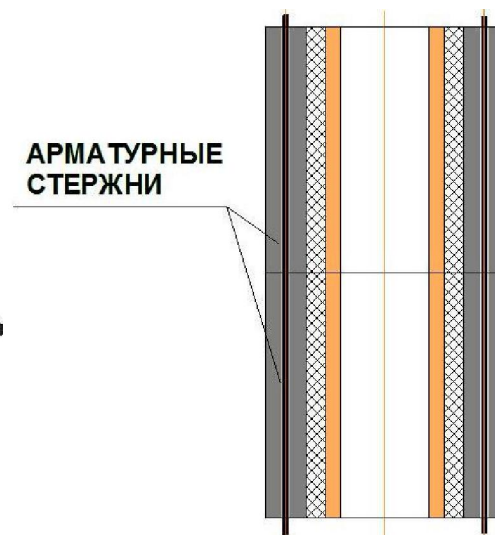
Расположение металлической арматуры при армировании конструкции дымохода (для Schiedel UNI)
